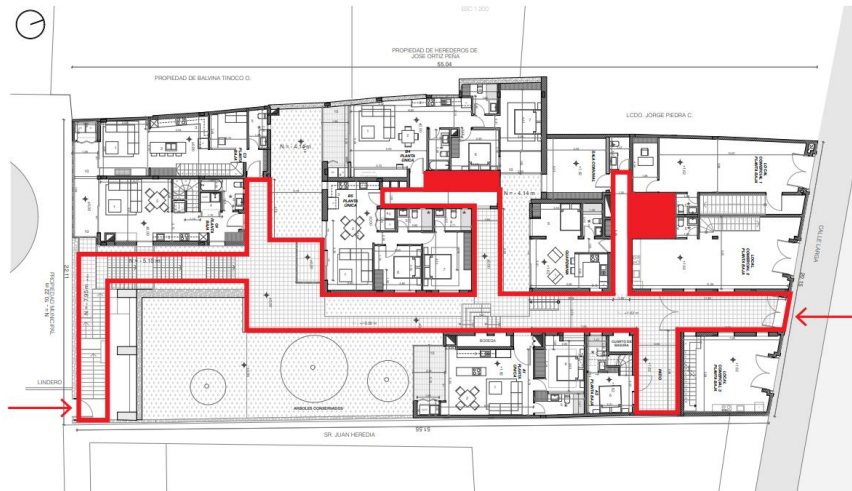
Circulación Casas del Ciprés, planta baja. Elaboración grupal.
